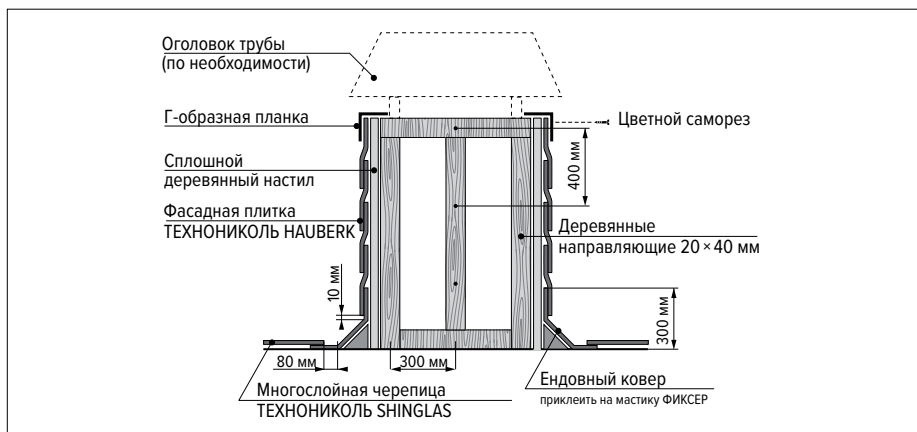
Монтаж фасадной плитки на вентиляционную трубу
